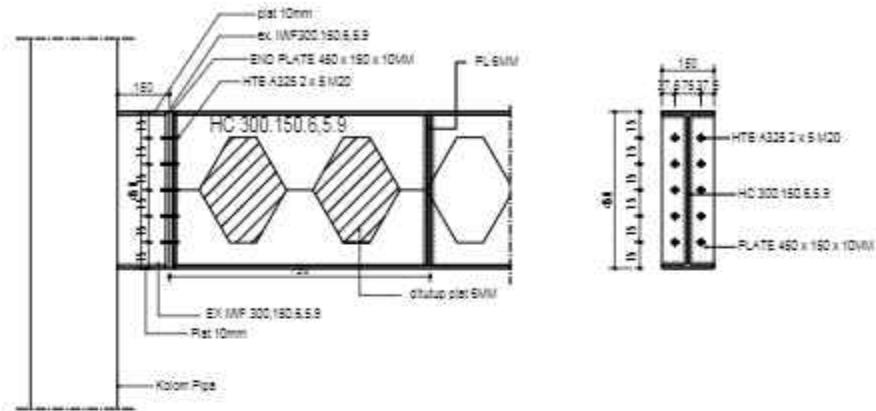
DETAIL HUB. BALOK HC 200 KE KOLOM (2)
